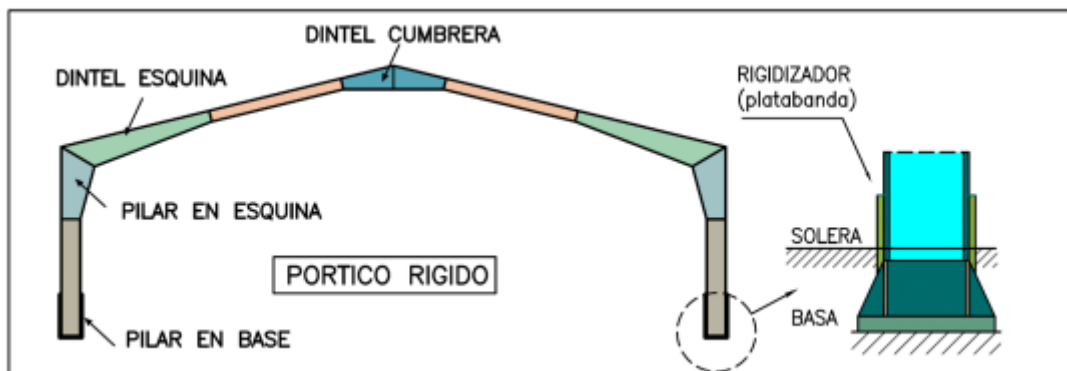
acartelamientos en pórtico rígido. Fuente: asignatura, Estructuras metálicas
